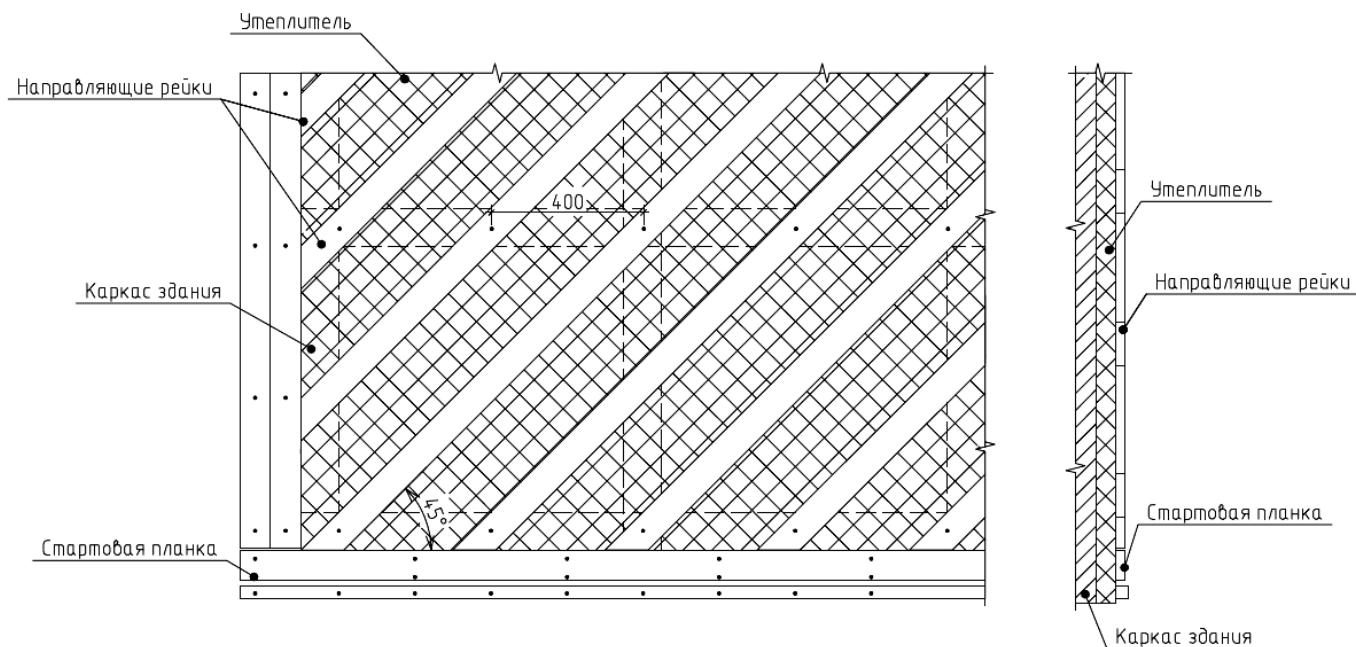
схема установки стартовой планки и направляющих для каркасной стены с утеплителем
